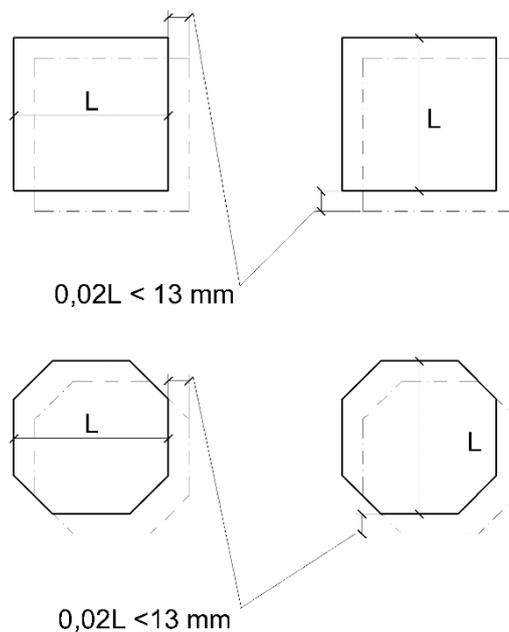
Vista en planta de la desviación horizontal permisible en la ubicación de fundaciones de elementos de mampostería.
